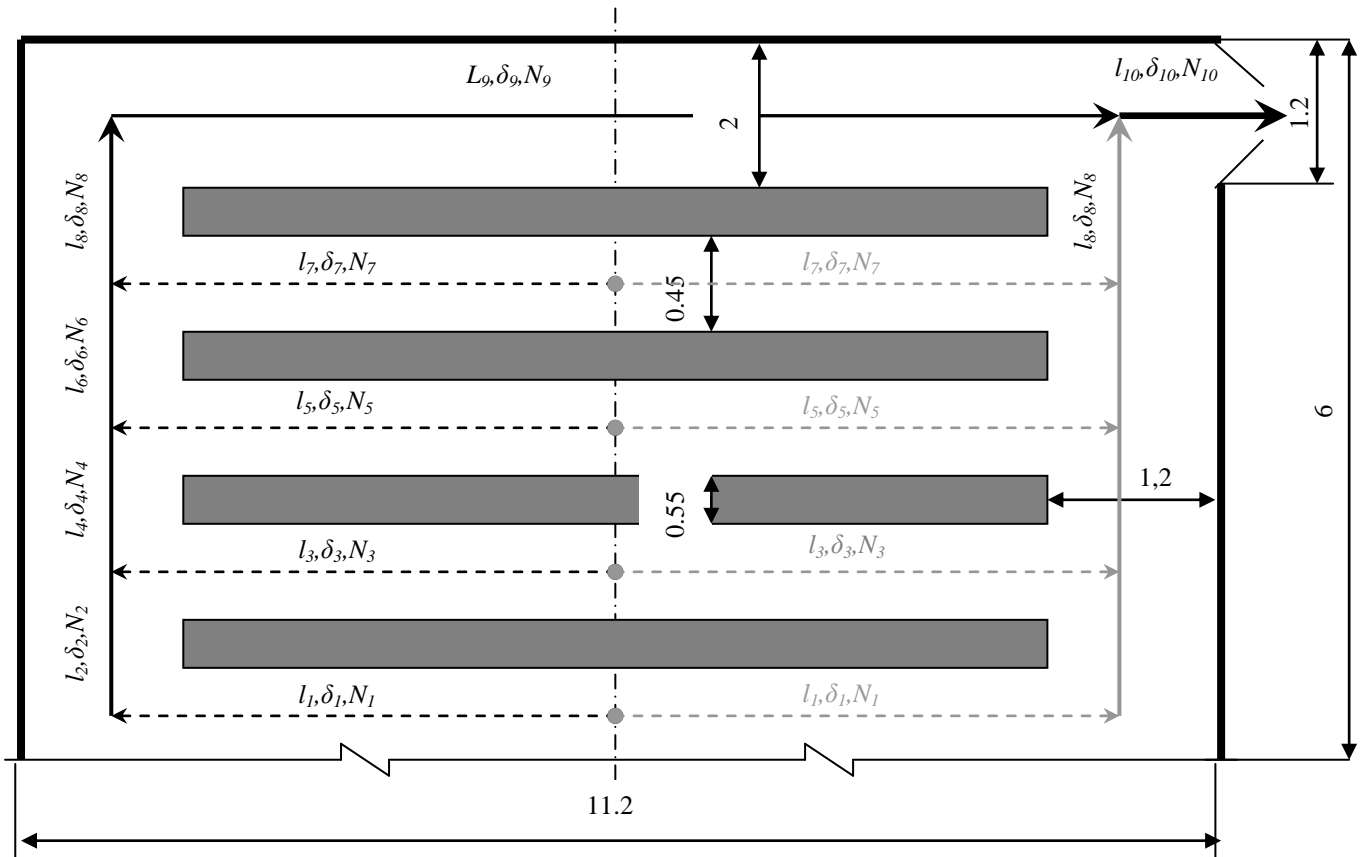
Фрагмент плану приміщення з розрахунковою схемою евакуації
